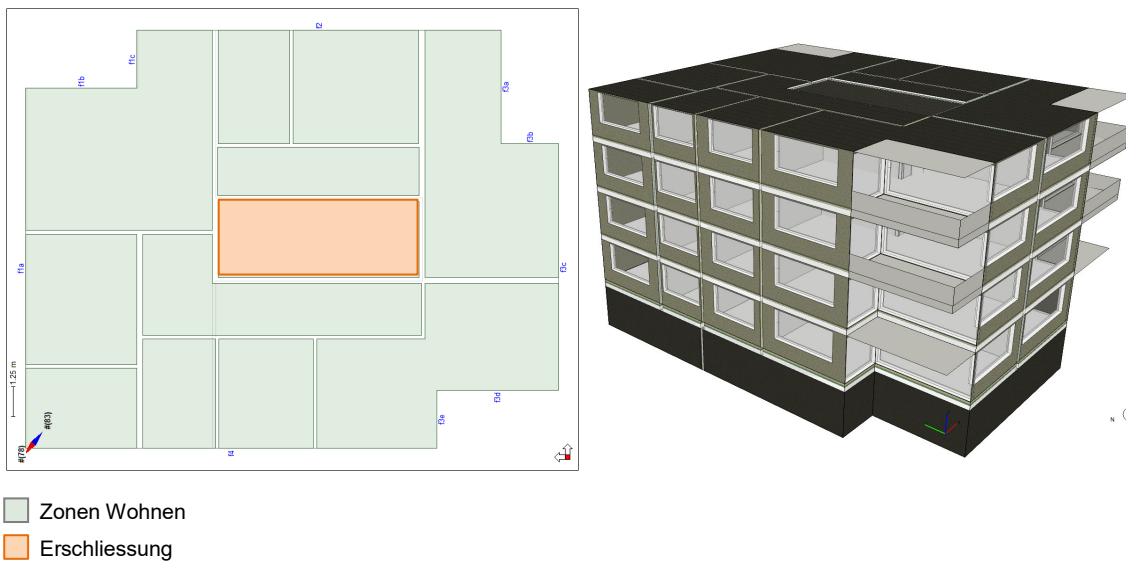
Grundriss mit Zoneneinteilung (links) und 3-D-Darstellung (rechts) des Wohngebäudes.
